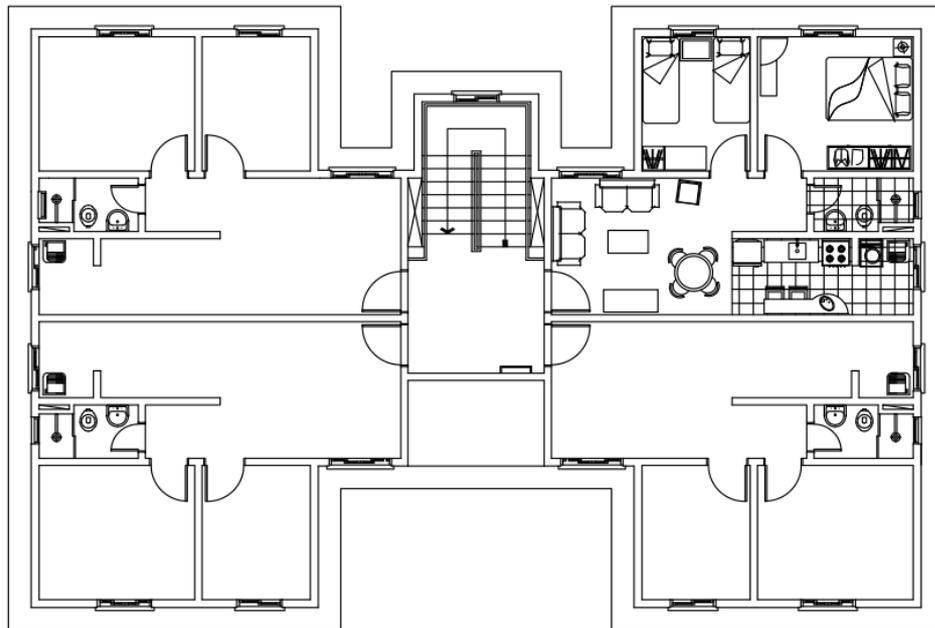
Plan de l'étage type de Videiras. Source : Architecte Elizabeth Moreira.
